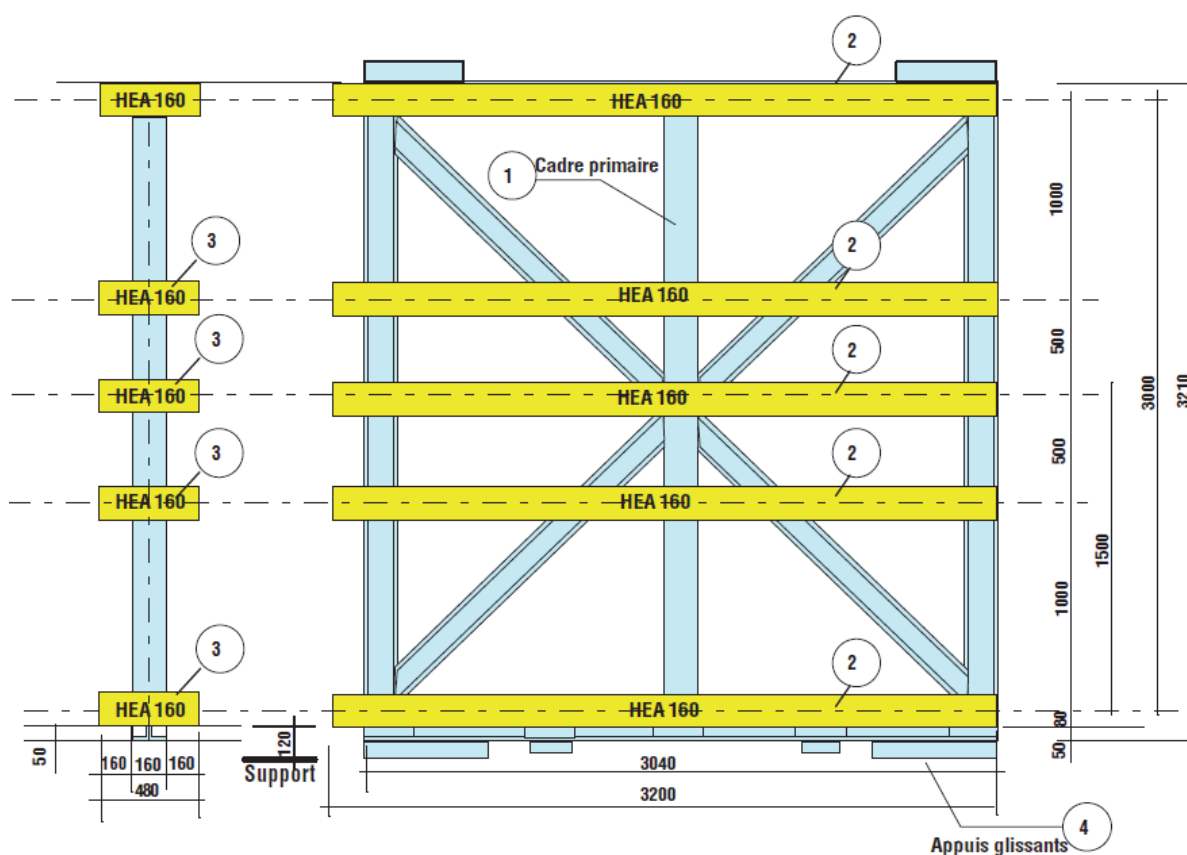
Schéma du dispositif pour les essais dynamiques dans le plan du support
